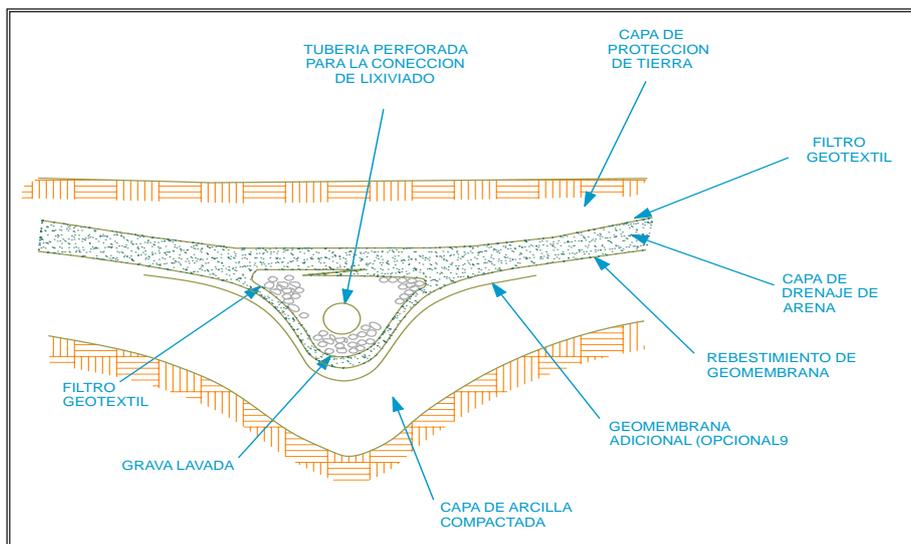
Detalle de una tubería para colección de lixiviado.
